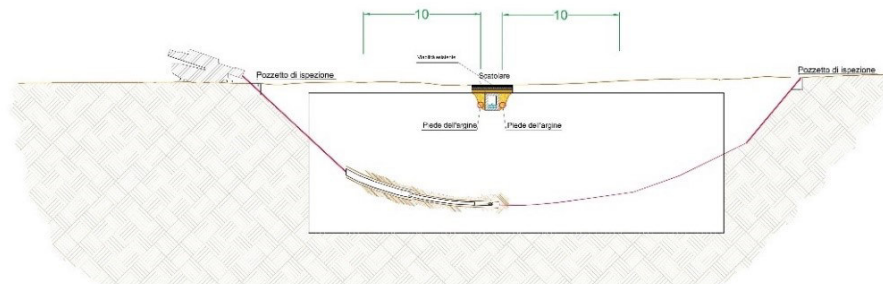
Attraversamento corso d'acqua localizzato lungo la viabilità esistente con il cavidotto 36 kV di collegamento tra la cabina di sezionamento e la stazione elettrica RTN "Borgo Zaffarana" e indicazione posizione scatolare esistente – estratto dell'elaborato di progetto "Tav.34 Inquadramento su CTR ante e post operam su bacini idrografici"
